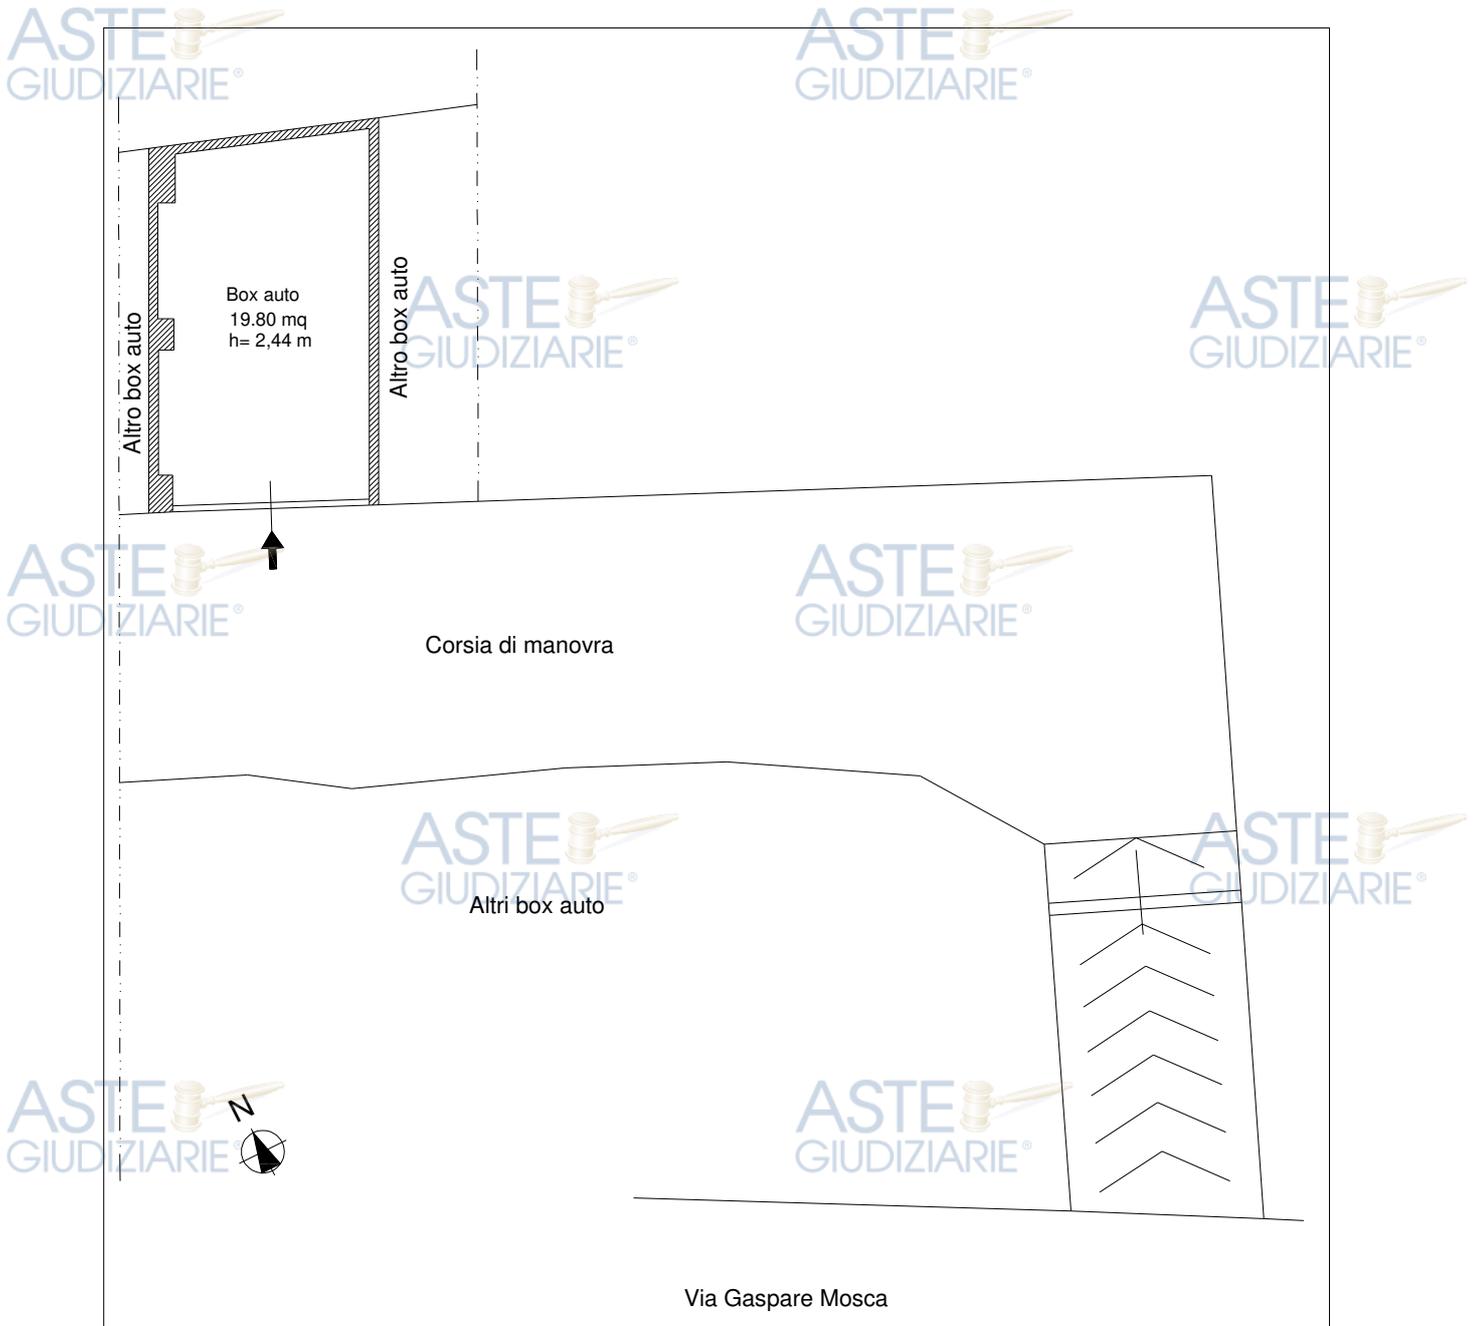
Pianta del locale garage pignorato – piano primo interrato
